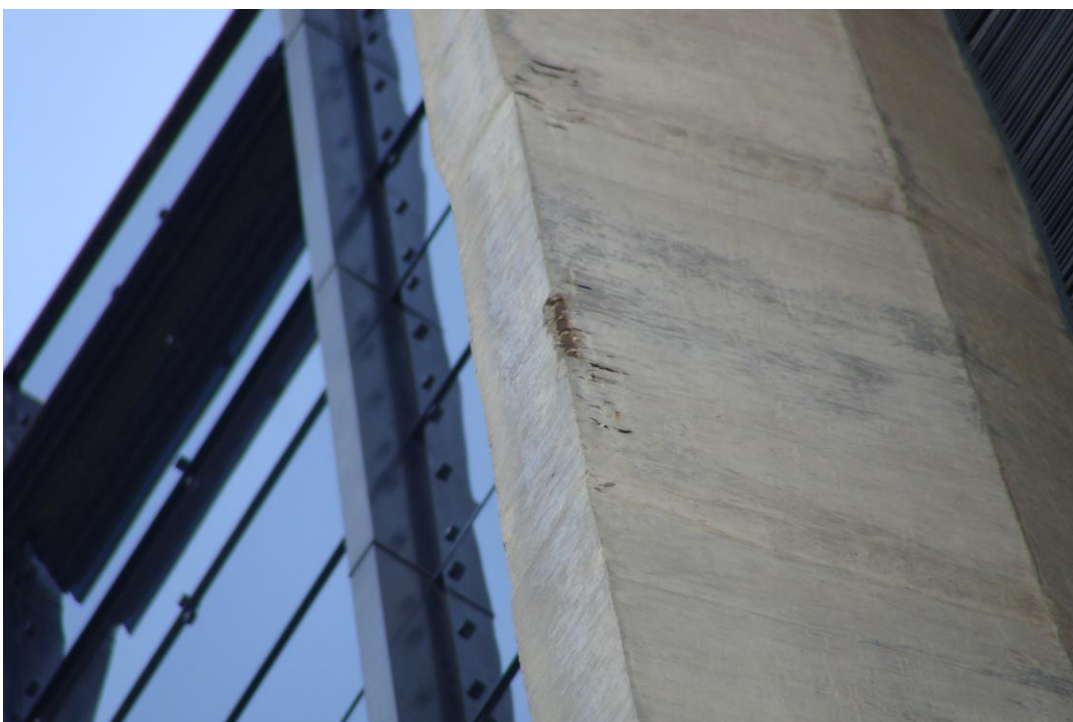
Armadura exposta pilar P14 (5º pavimento) (19/11/2013)
